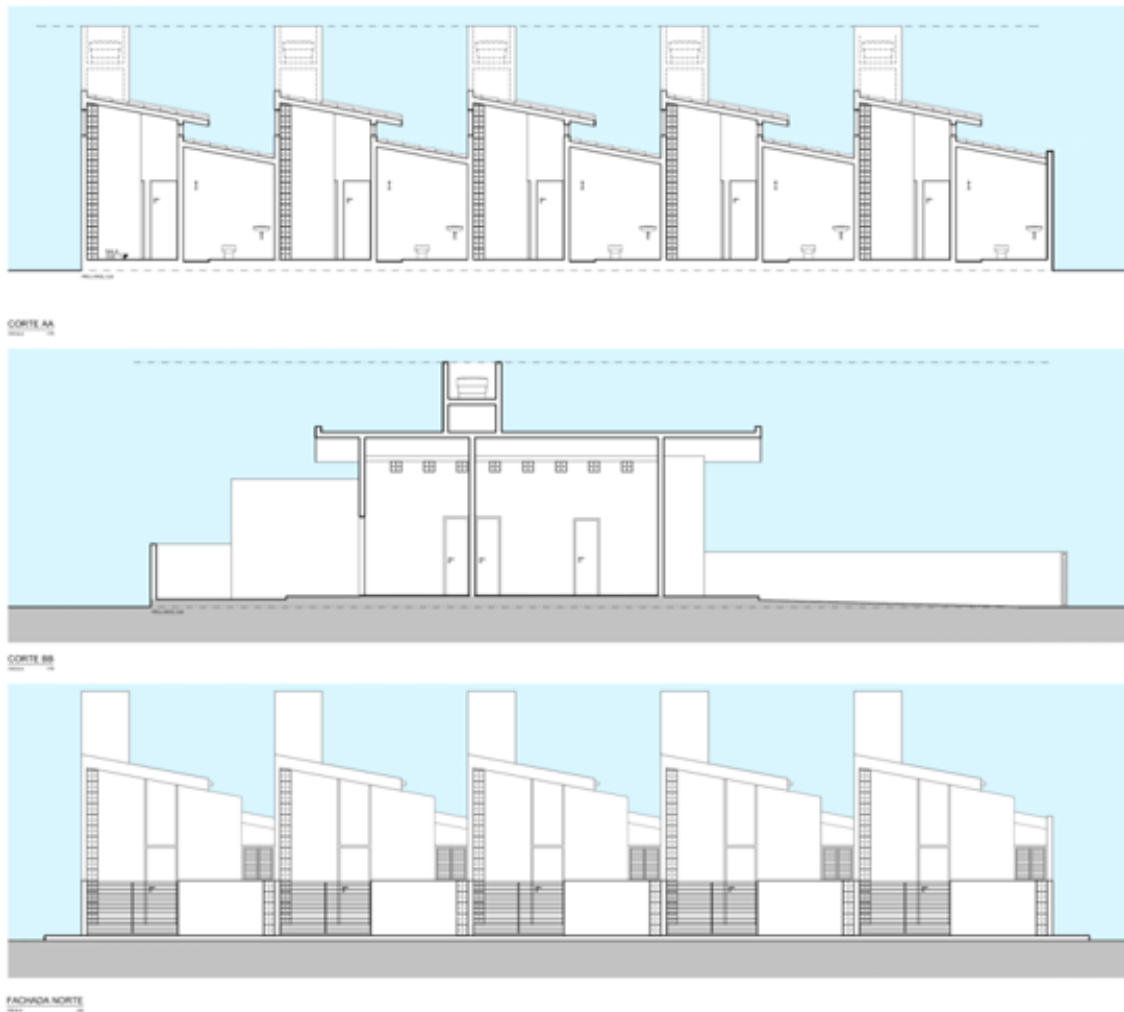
, 68 e 69. Cortes e fachadas do Protótipo 01 com laje inclinada pré-fabricada em compósito cimentício. Fonte: Elaborado pelo autor, 2016.
